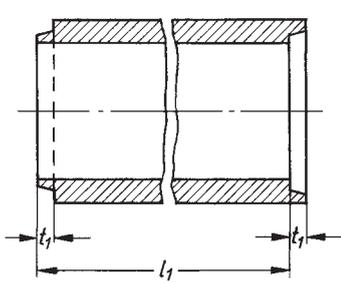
Betonrohr mit Kreisquerschnitt ohne Fuß (K), mit Falz (F)
